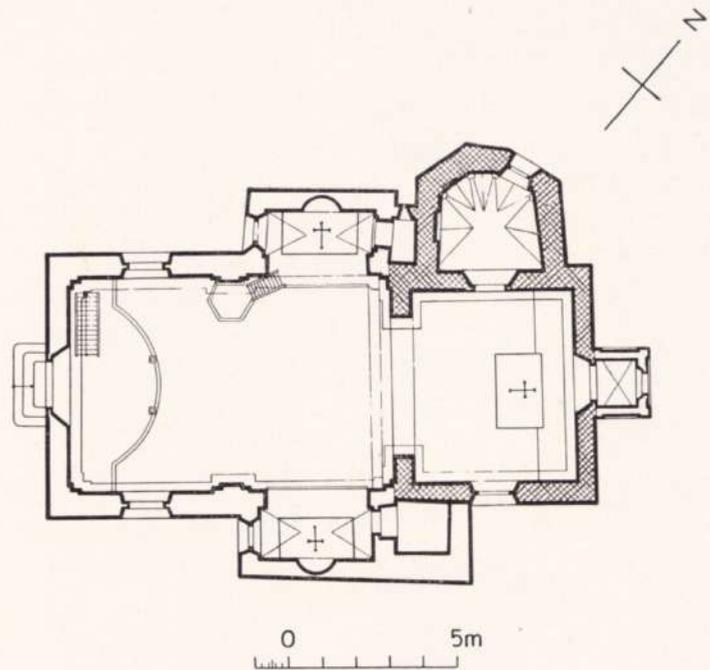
Grundriss. — Maßstab 1:300. Die schraffierten Mauerzüge gehören zur ersten Bauperiode. Text S. 144.
